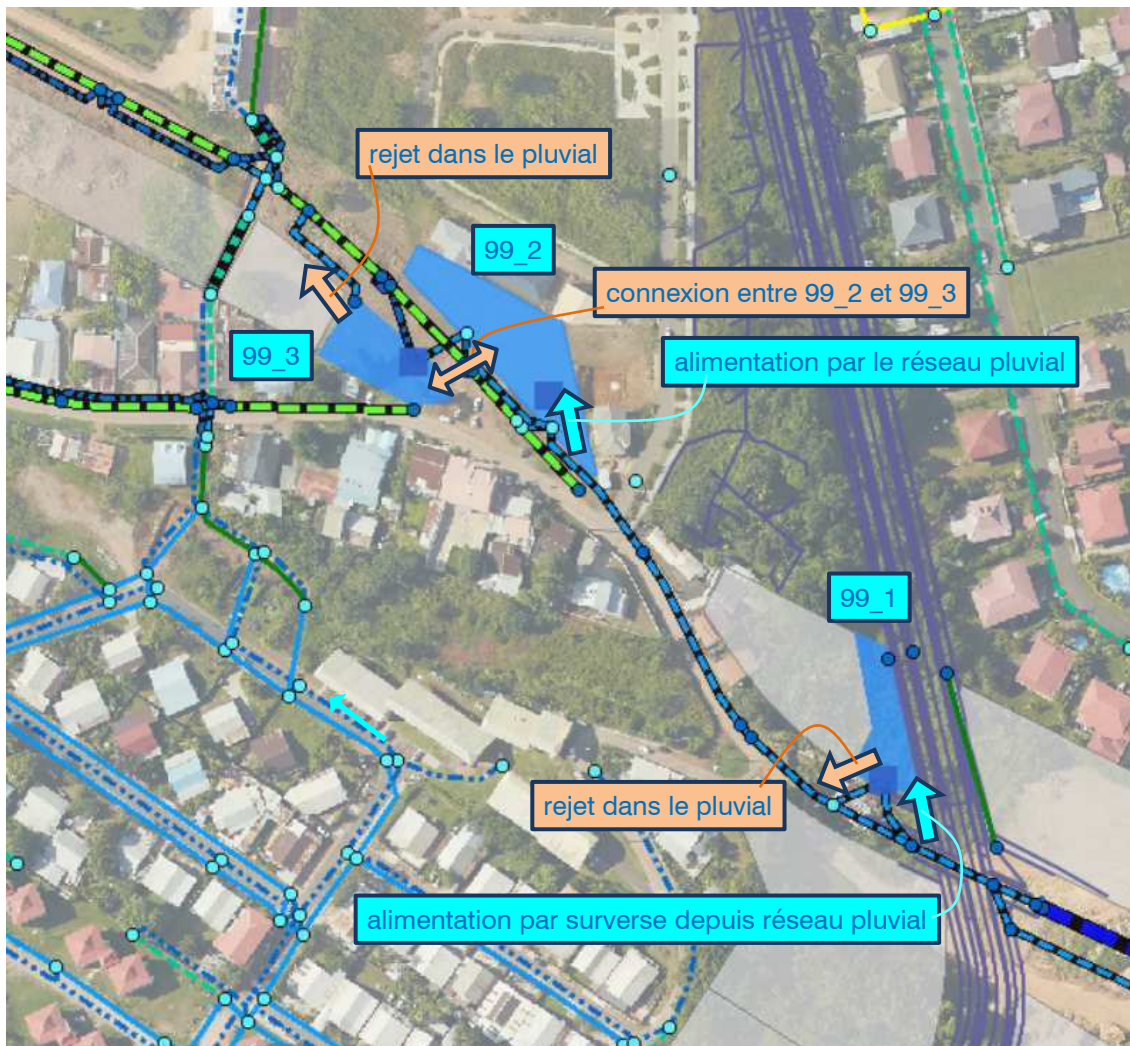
extrait du plan projet du bassin 99\_1 (planche E)
